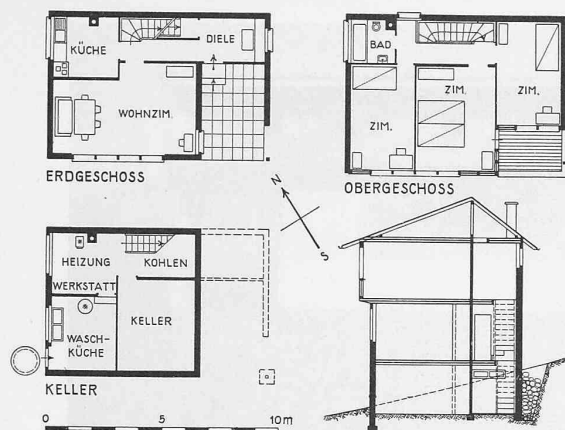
und 16. Grundrisse 1:300 und Ansicht des Hauses in Erlenbach.
